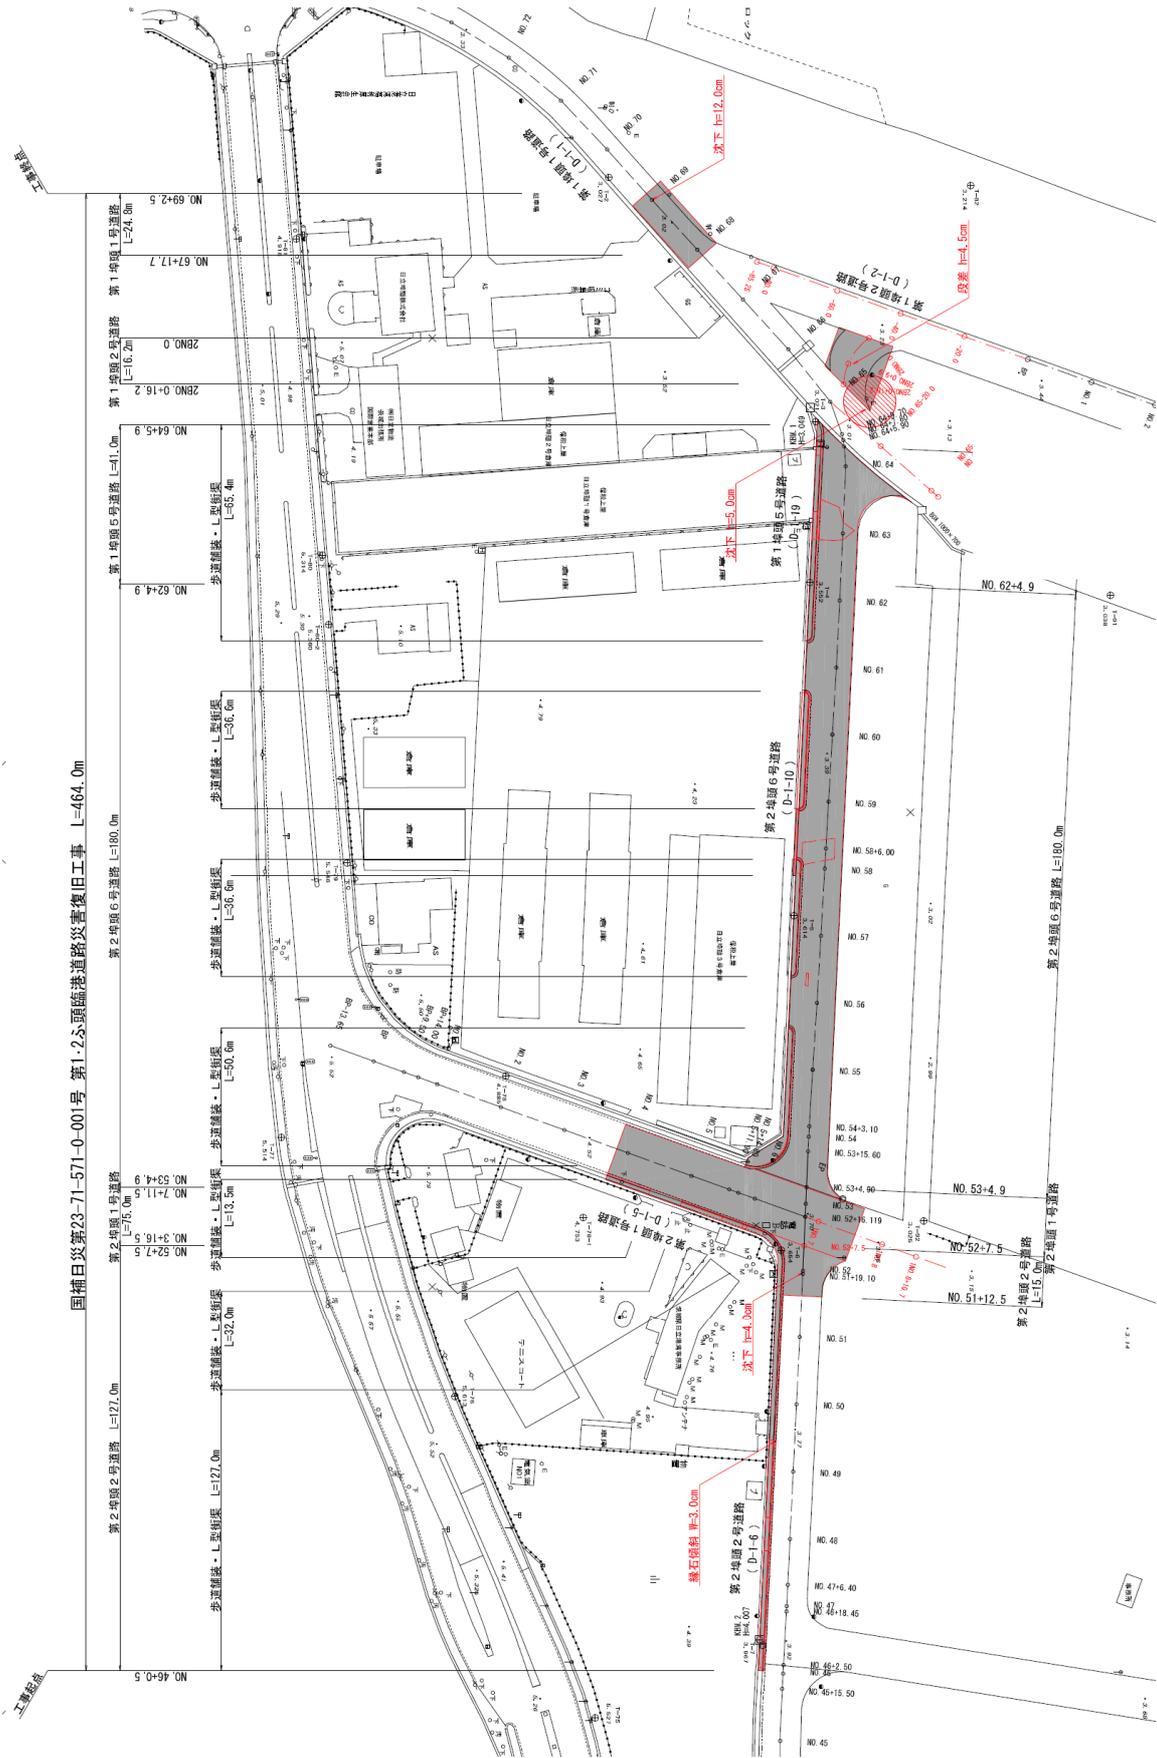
No.2 日港区_第1埠頭1号·2号·5号道路、第2埠頭1号·2号·6号道路の平面図 (復旧後)
